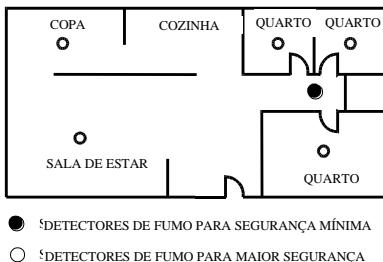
Locais de instalação para detectores de fumo/calor em apartamentos ou casas para uma família com apenas uma área de dormitório
